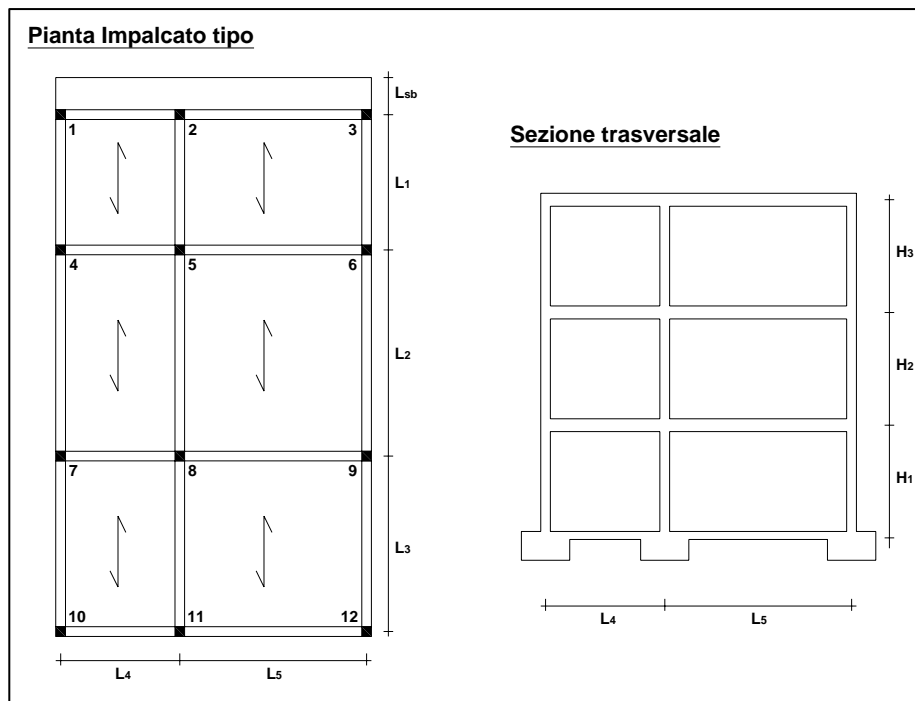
Schema dell'impalcato tipo e della sezione verticale dell'edificio
